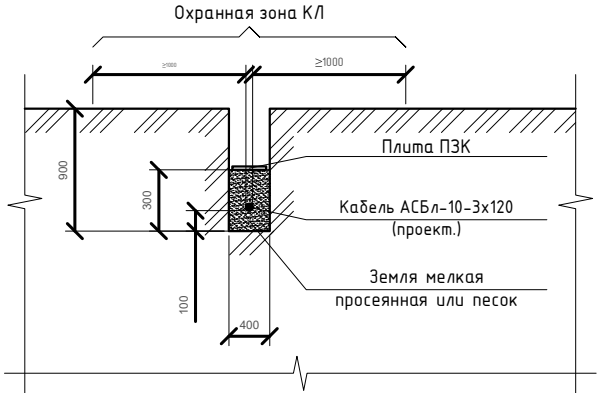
Поперечный разрез кабельной траншеи с 1 КЛ
